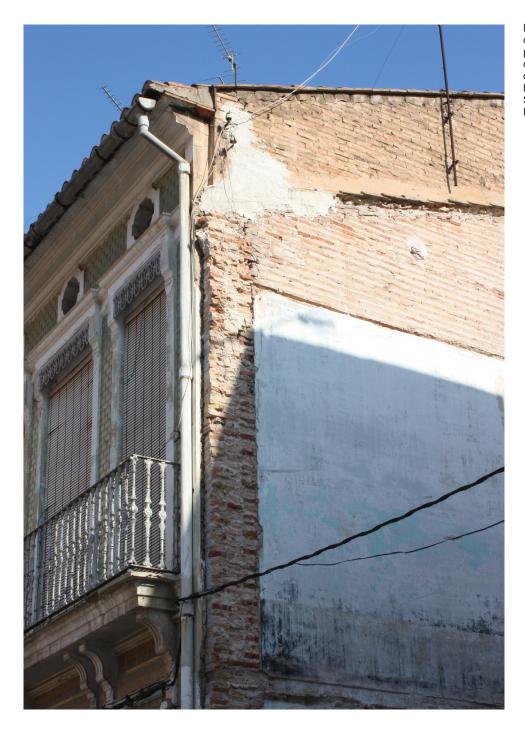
Muro de carga de fachada principal realizado con ladrillo macizo del edificio que estaba construido en calle San Pedro. (Pastor, R. 2011)
